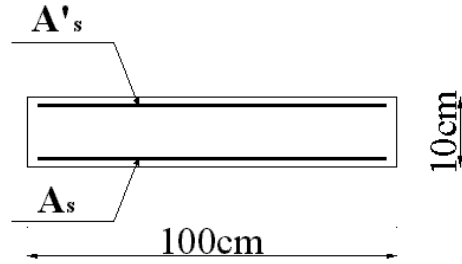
Coupe transversale sur l'acrotère.
